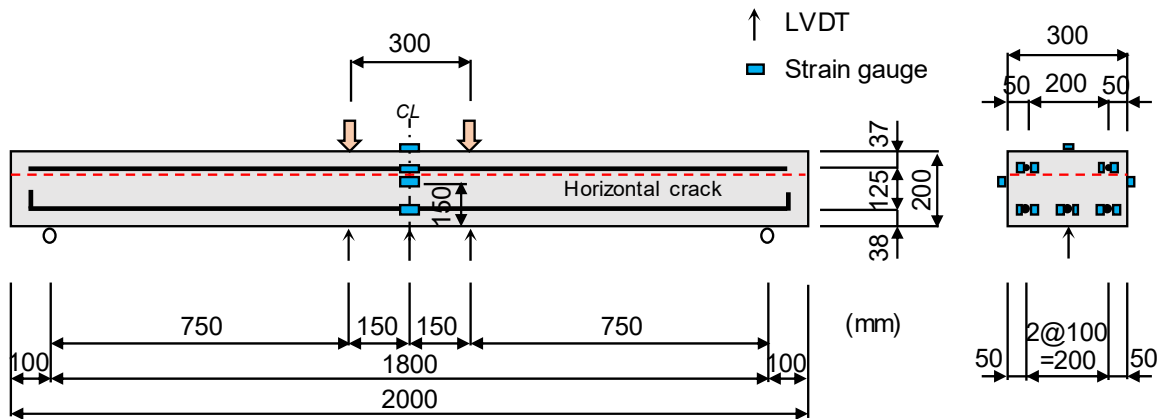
水平ひび割れを有する試験体の形状寸法および計測位置
